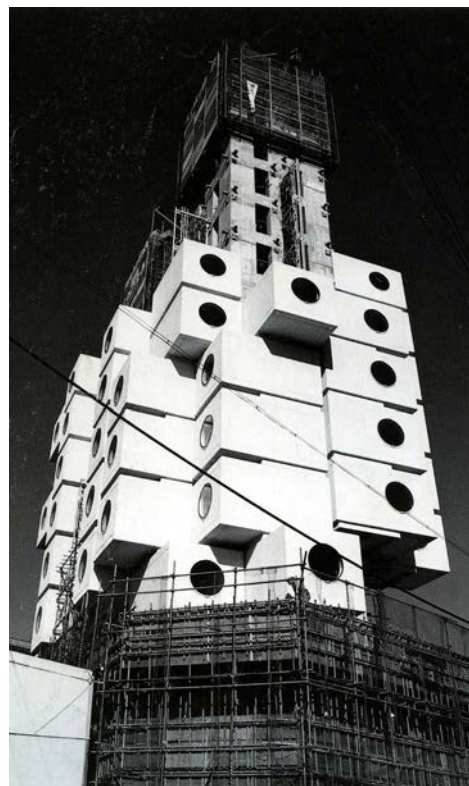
Montaje de las cápsulas en la estructura general de las torres.
